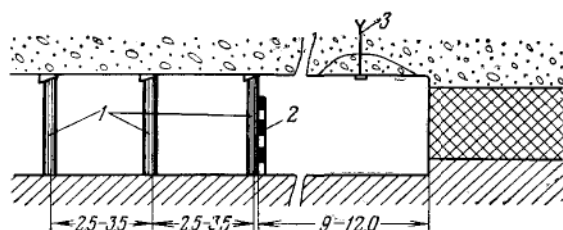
Крепление рядами стоек очистных выработок вечномерзлых россыпей:
